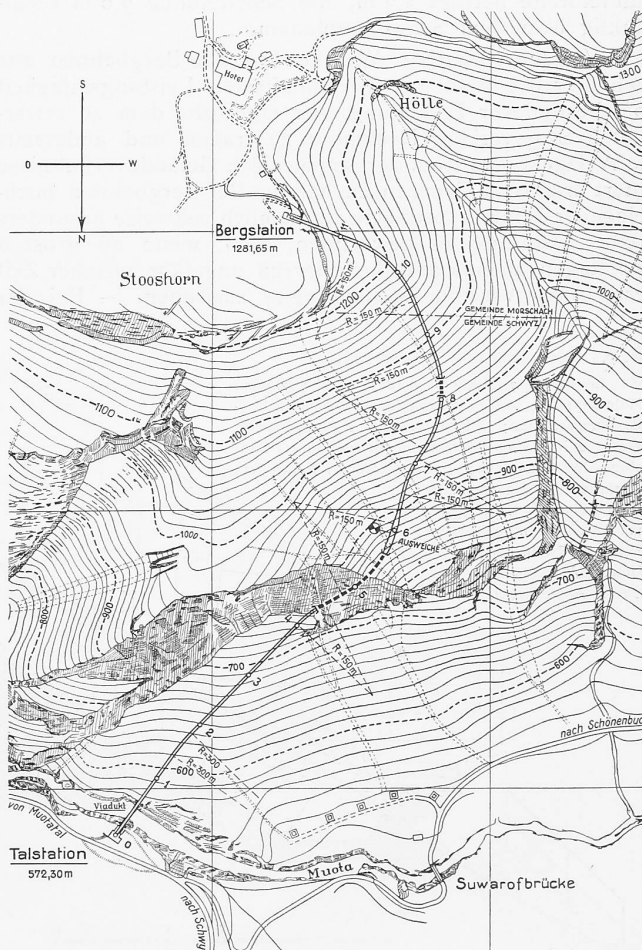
Lageplan der Seilbahn Schwyz-Stoos. — Masstab 1 : 10 000.
